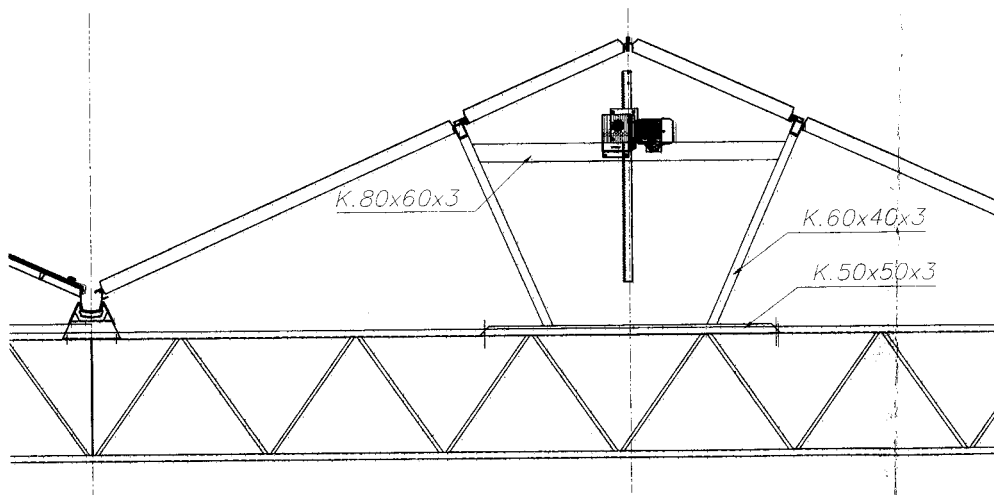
Doorsnede van de spantconstructie(oorspronkelijk ontwerp).⁶
